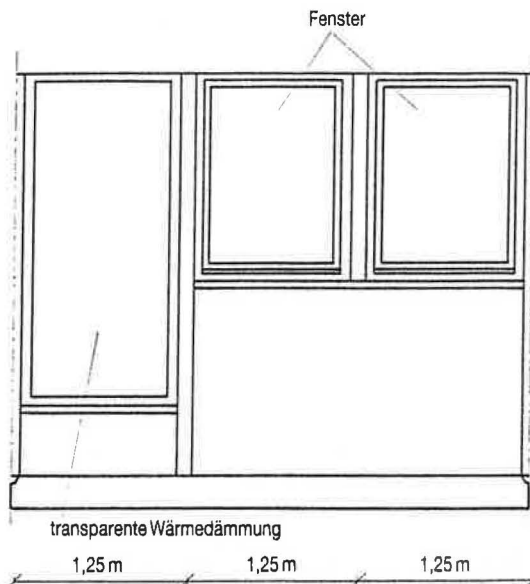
Fassadenausschnitt für einen Büroraum (3-Raster) mit Außenwandelement aus transparenter Wärmedämmung.
